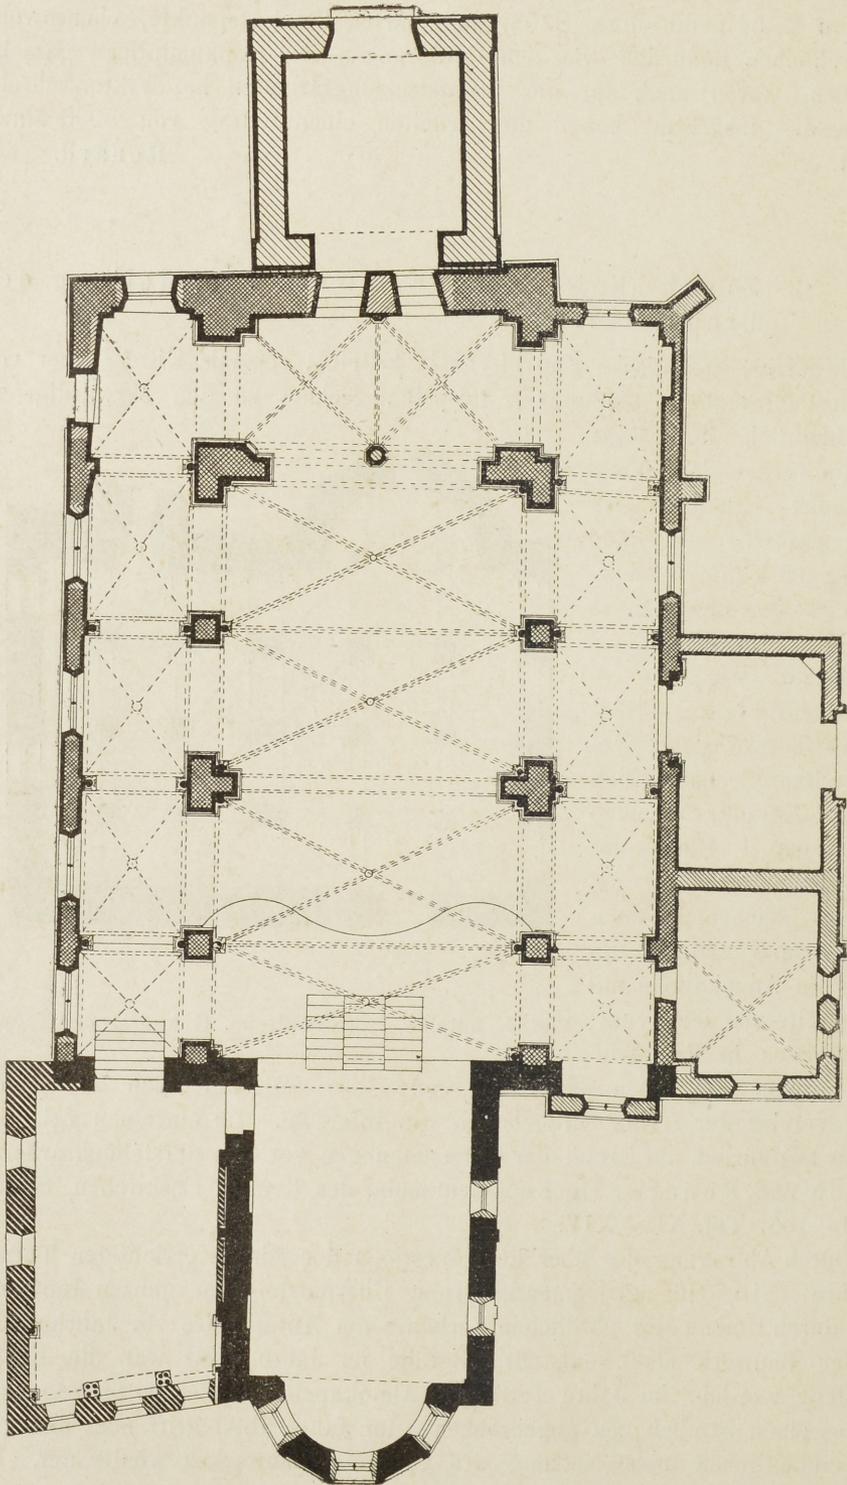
Zülpich, Propsteikirche. Grundriss vor der Wiederherstellung.
